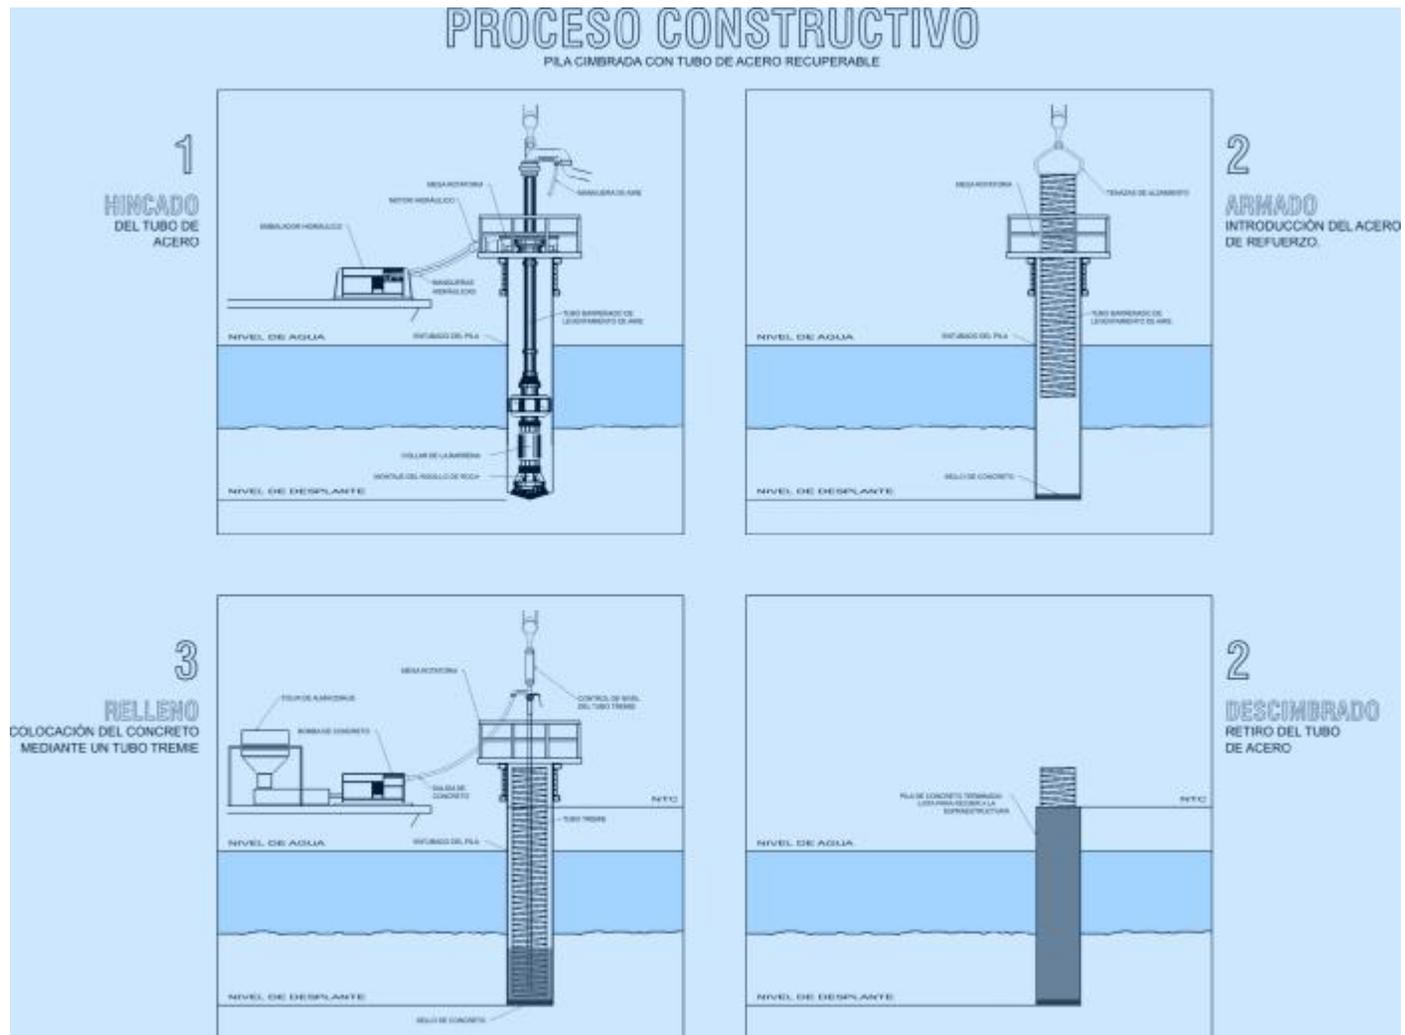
Proceso constructivo de pilas con cimbra metálica recuperable.
